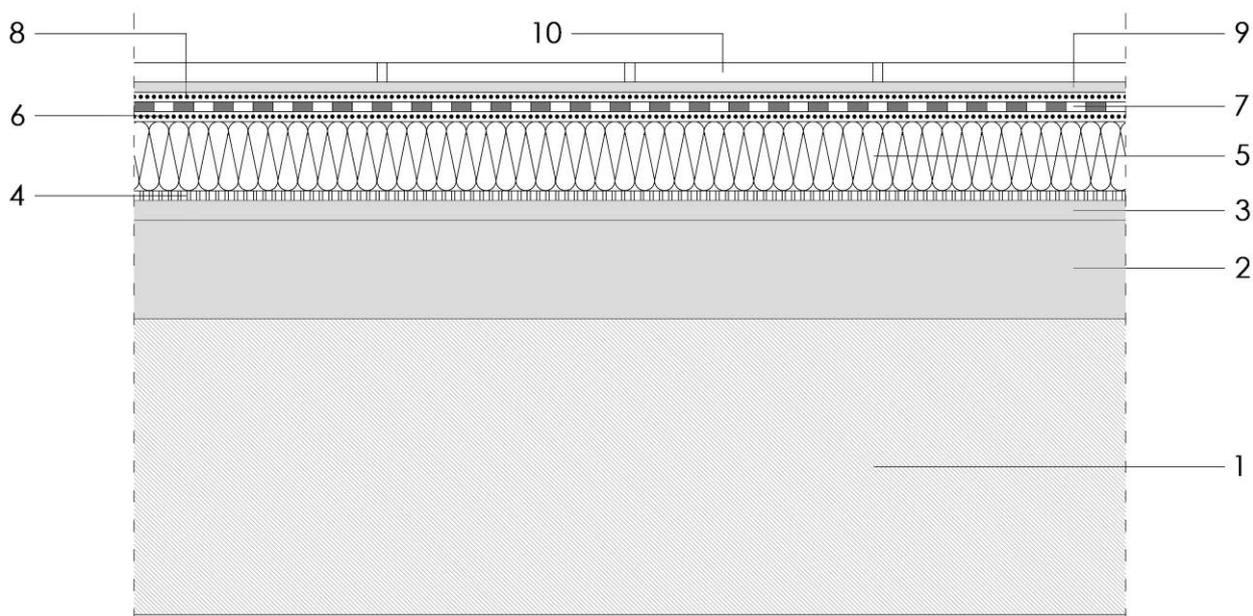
Detalle constructivo de cubierta caliente convencional.
